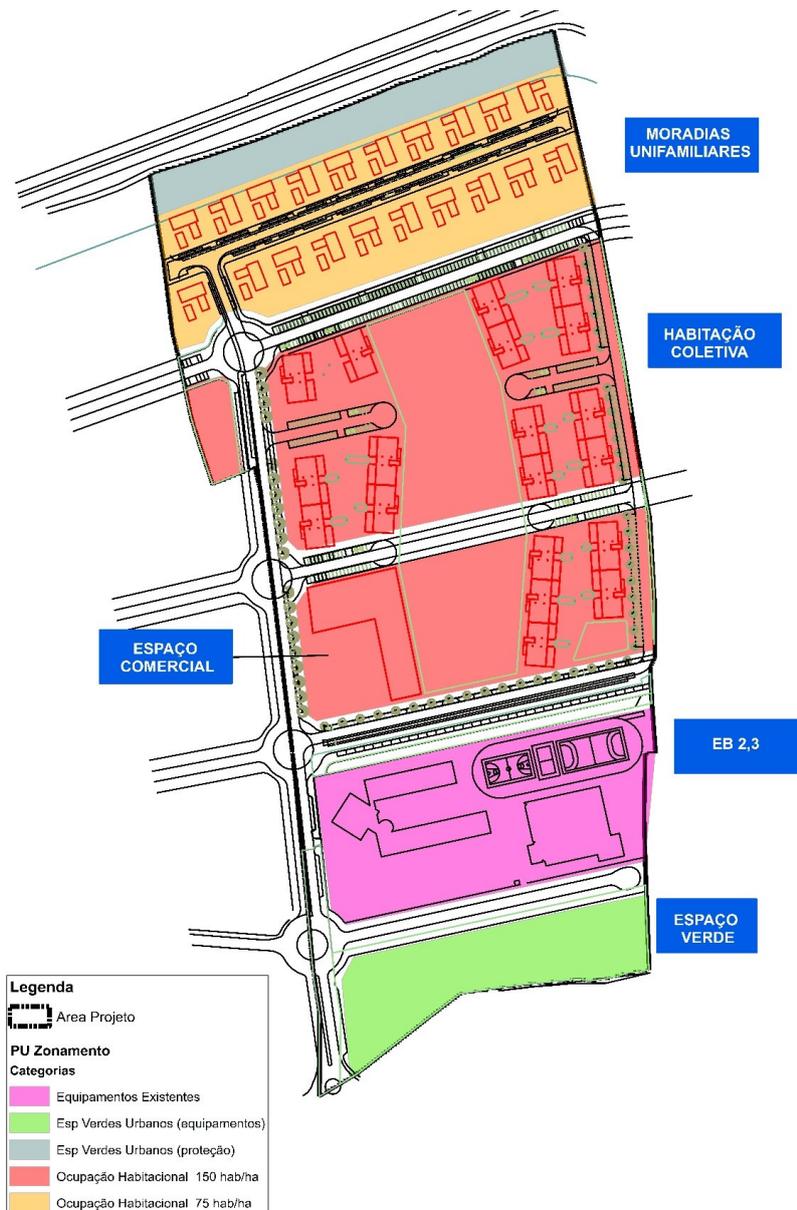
Sobreposição do Loteamento à Planta de Ordenamento do PU da Cidade de Lagoa
